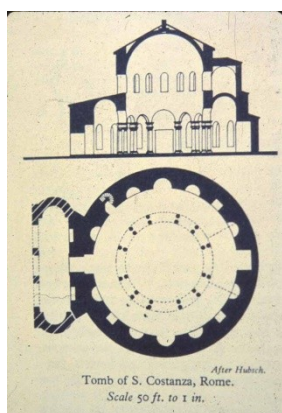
Plan circular și vedere exterioară, Biserica Santa Costanza, sec. al V-lea, Ravenna.
